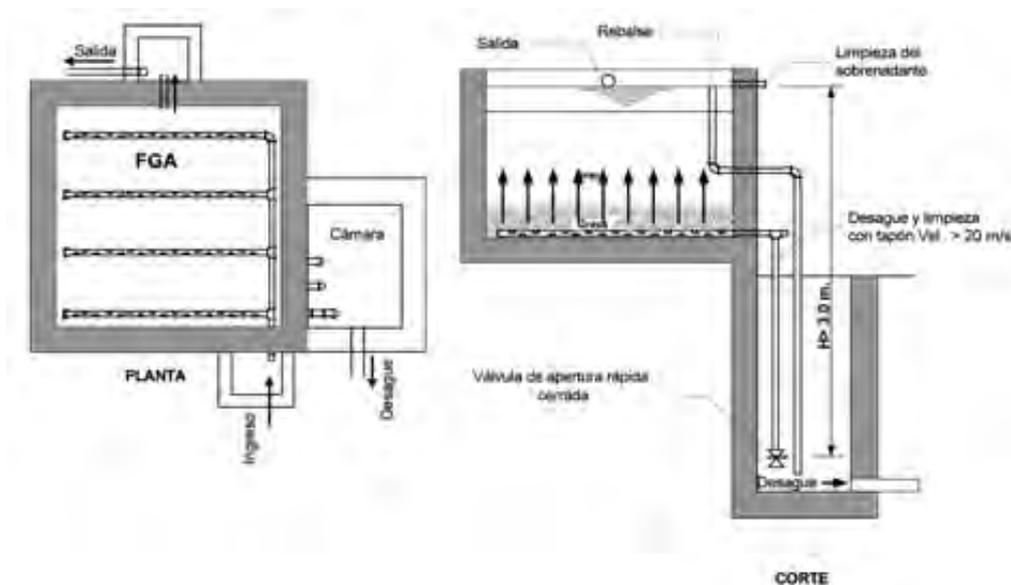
Vista en planta y perfil de un filtro grueso ascendente
